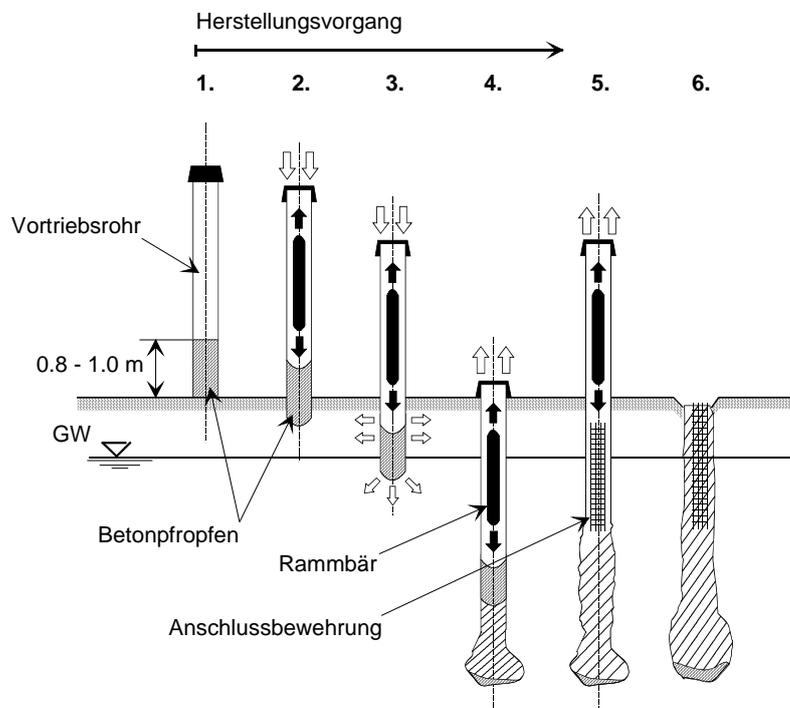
Herstellungsvorgang OB-Pfahl mit Innenrammung
